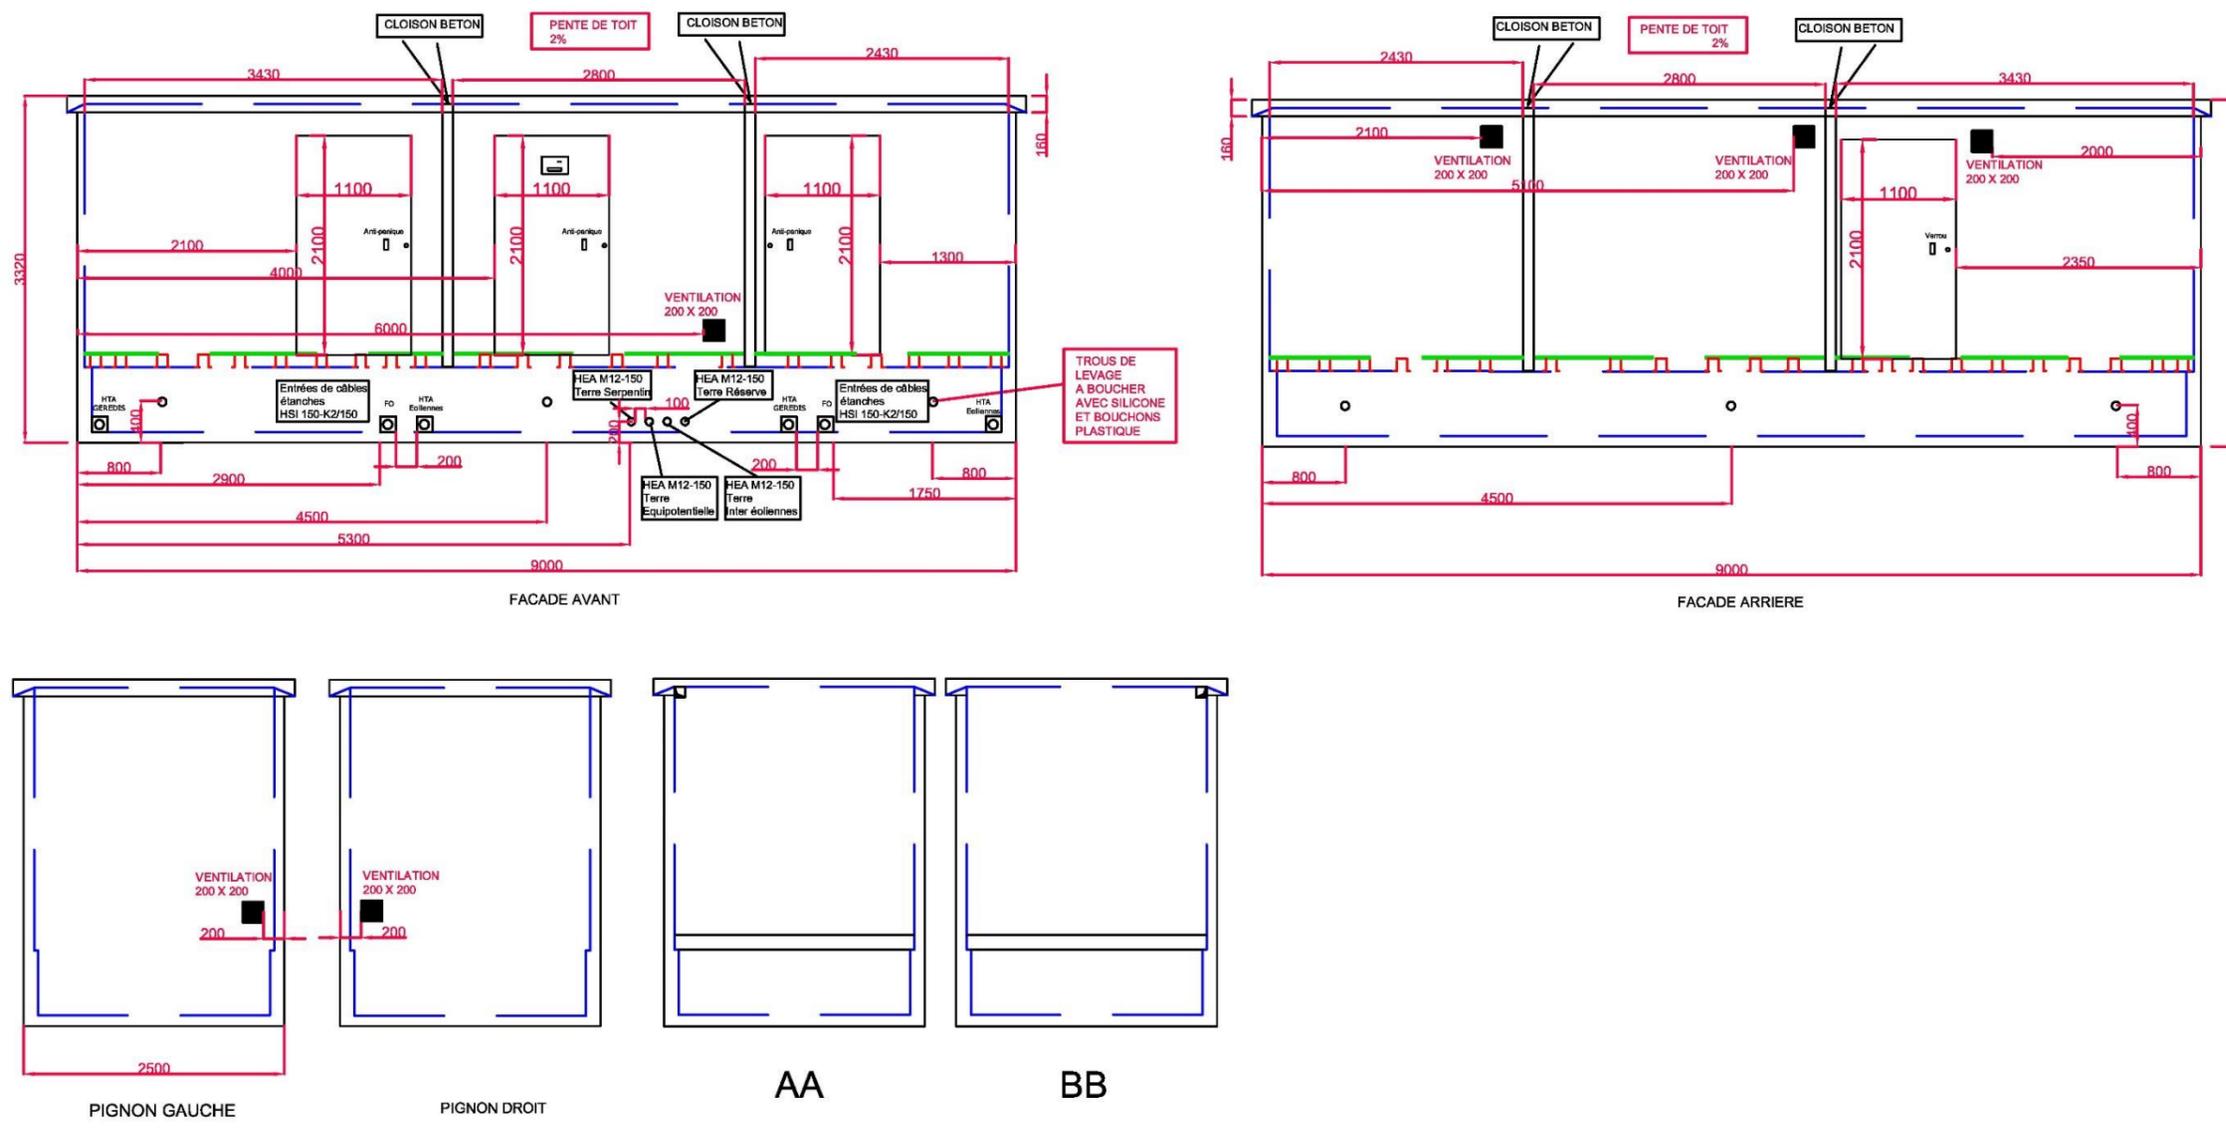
Exemple de plan d'un poste de livraison de 2,5 x 9 m² (double)
